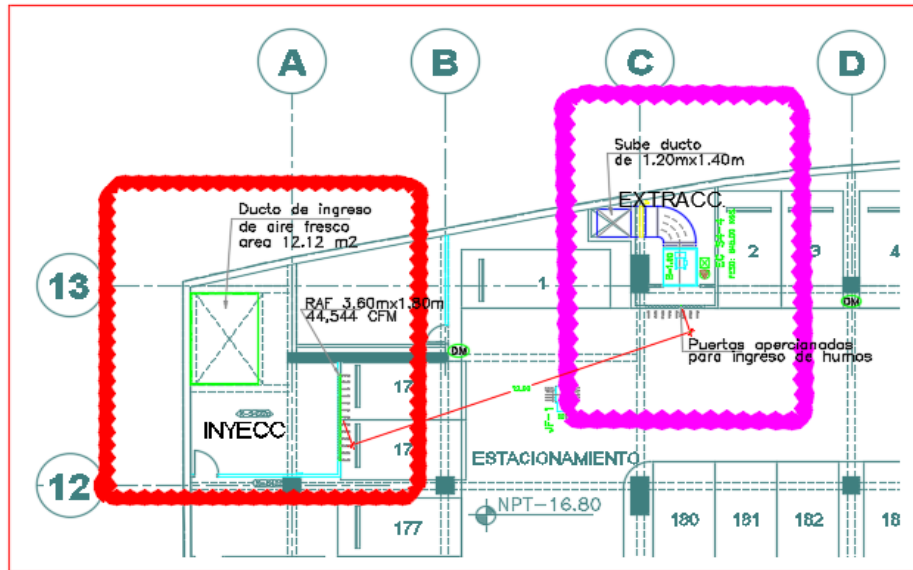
PLANTA PARCIAL 4º SÓTANO – EJES 13,12-A Y 13,12-C
